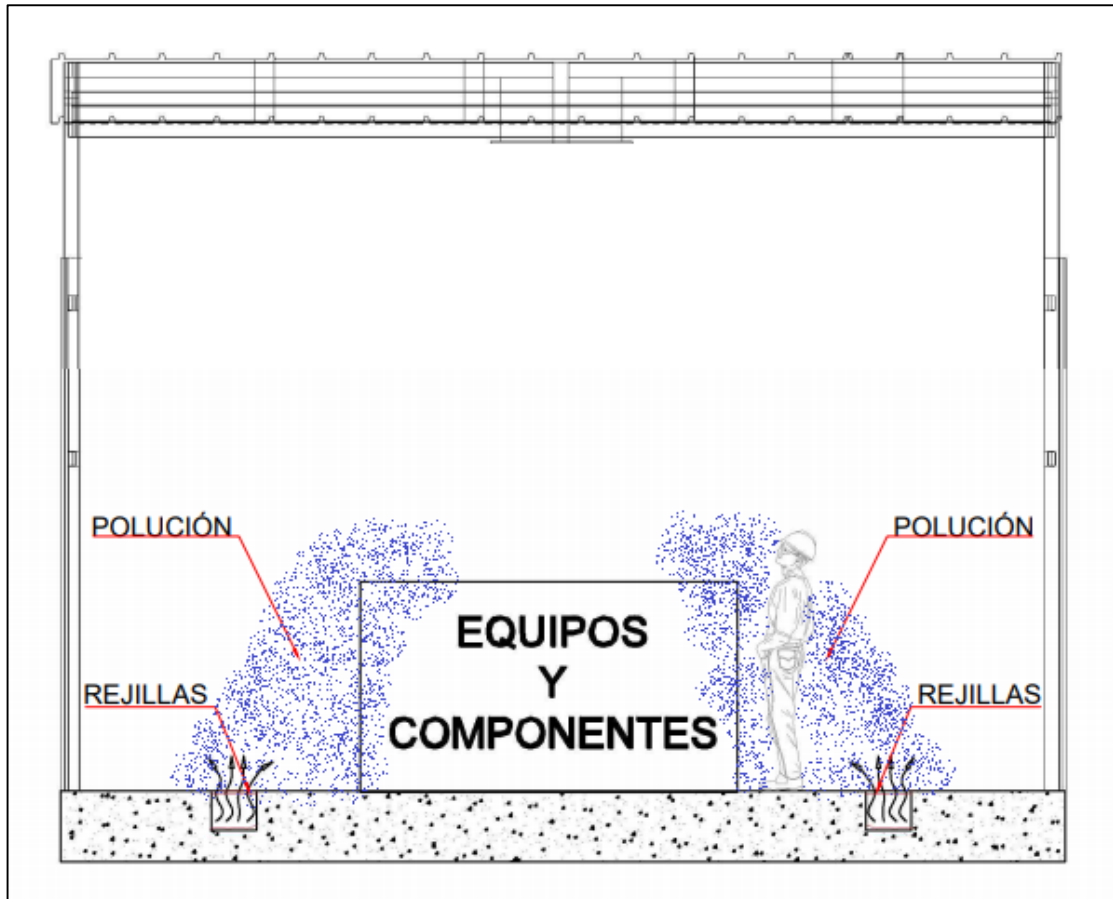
Zona de Lavado de la planta Komatsu - I
